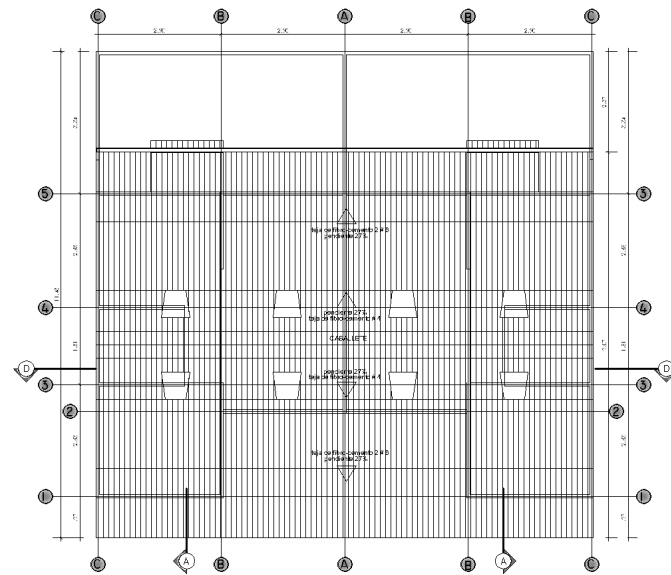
planta arquitectónica cubierta (muros prefabricados-SC).
